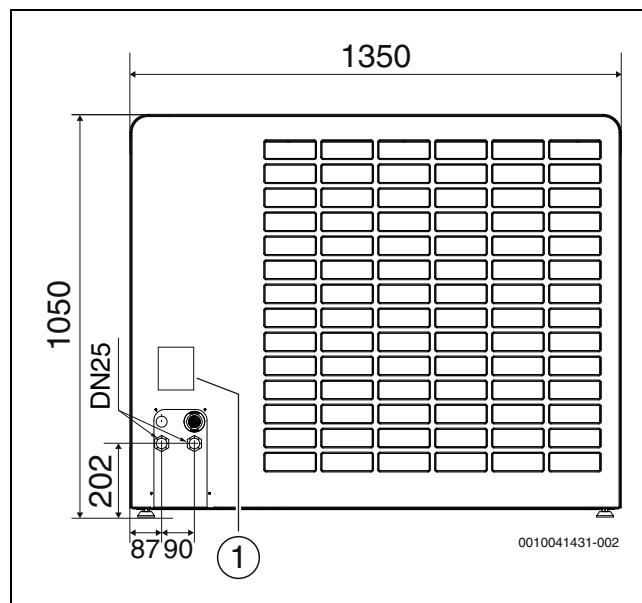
Dimensions et raccords de la pompe à chaleur, arrière
